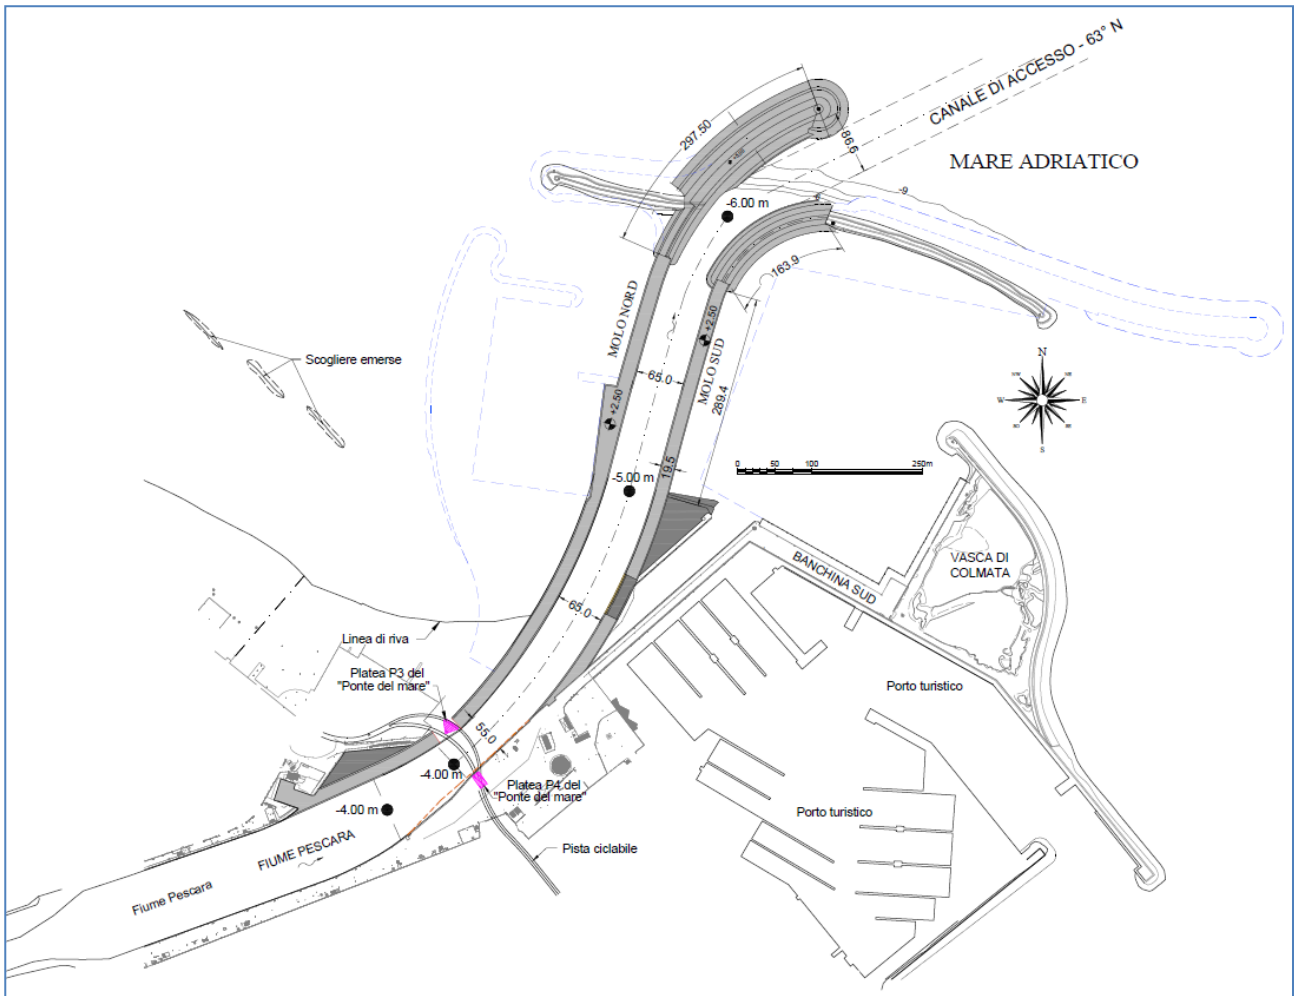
Soluzione A - protezione delle fondazioni del Ponte sul mare con pali affiancati (planimetria generale e dettaglio in corrispondenza dell'intersezione del fiume con il Ponte del mare).
